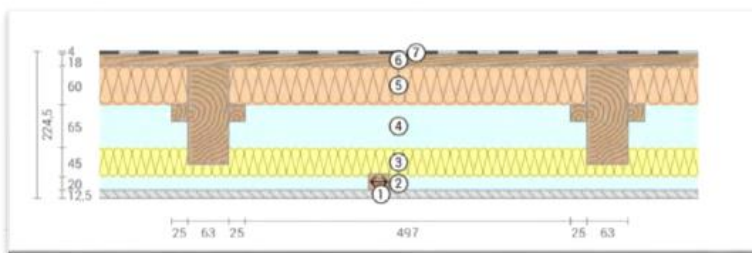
P03 Plat dak met 2 lagen SuperQuilt: tussen en onder de balkconstructie
